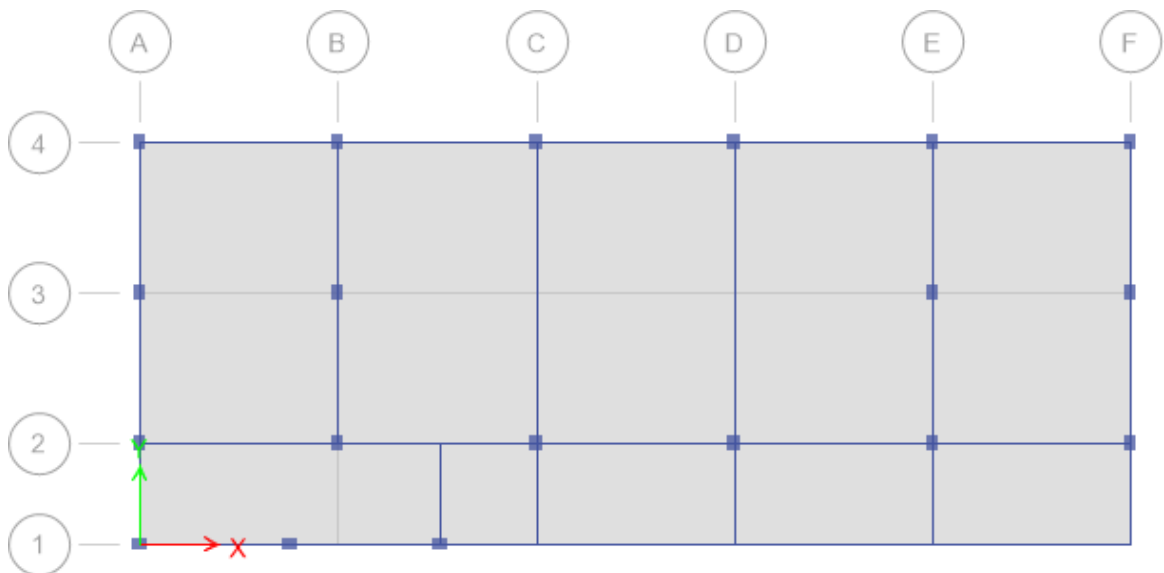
Vista en planta de la edificación sin reforzamiento. Fuente: Elaboración propia.
